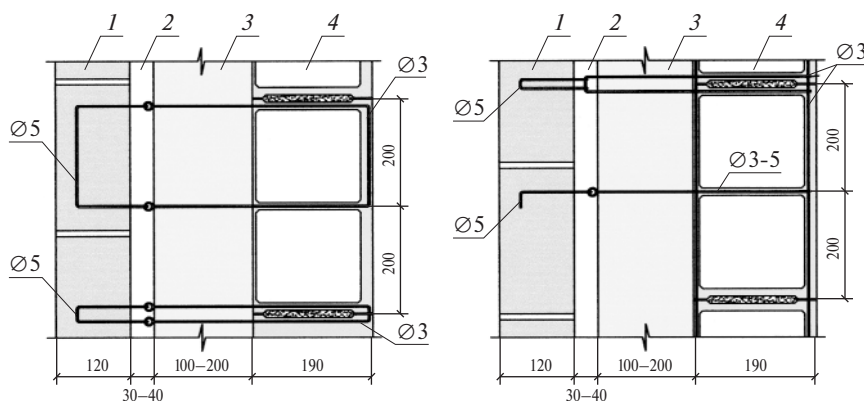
Примеры установки двухъявневых регулируемых связей в кладку из бетонных блоков с крупными пустотами: 1 – кладка наружного слоя из кирпича; 2 – воздушная прослойка; 3 – утеплитель; 4 – кладка внутреннего слоя из бетонных камней с крупными вертикальными пустотами
